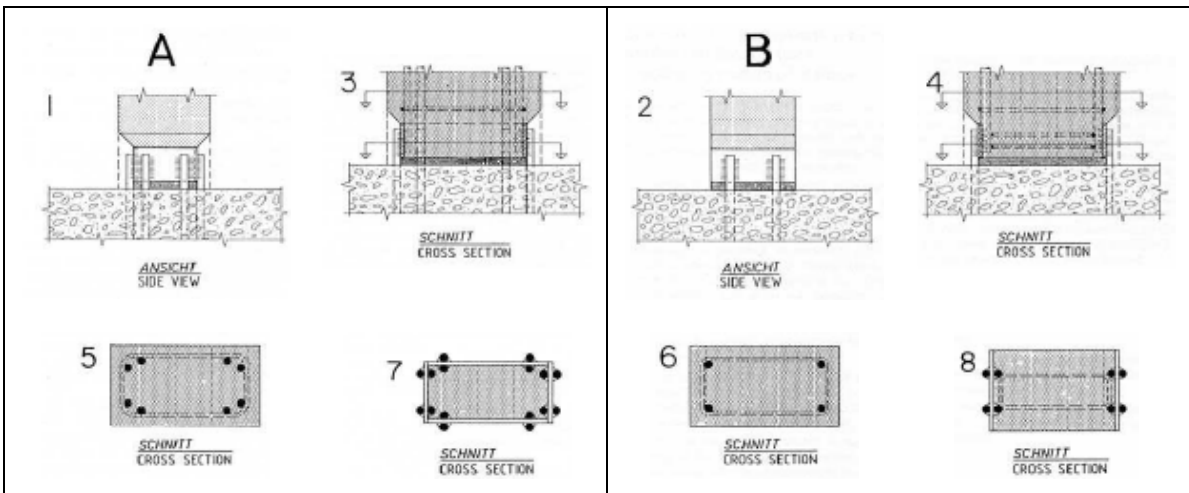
Ligação por soldadura a chapa e varões (Stupré, 1981)
